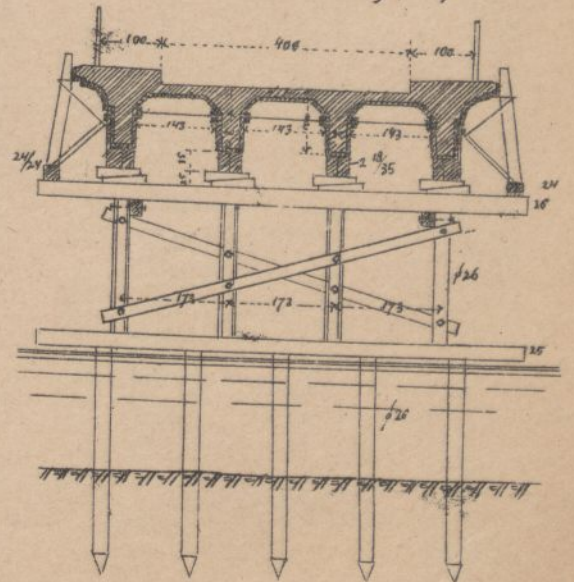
Zdjęcie krążym za pomocą walców z piaskiem.
